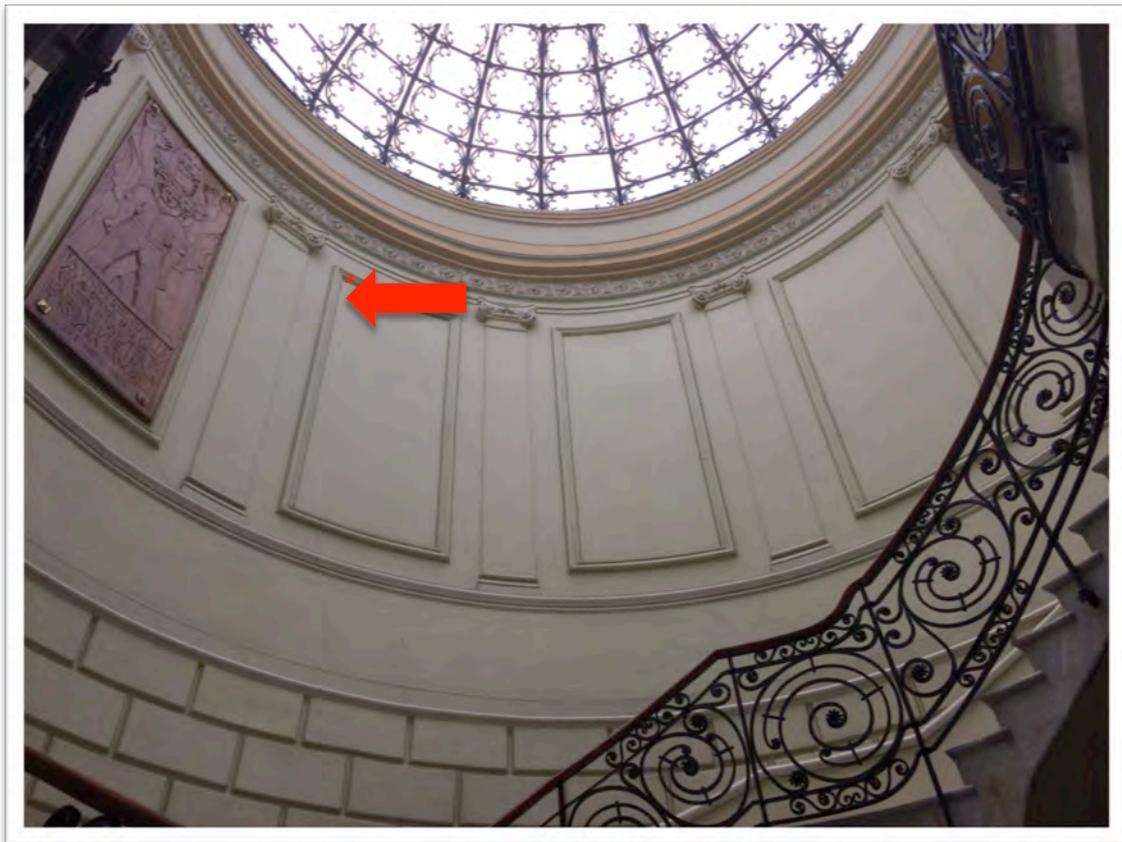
Grietas y escurrimientos en muros de escalera.
